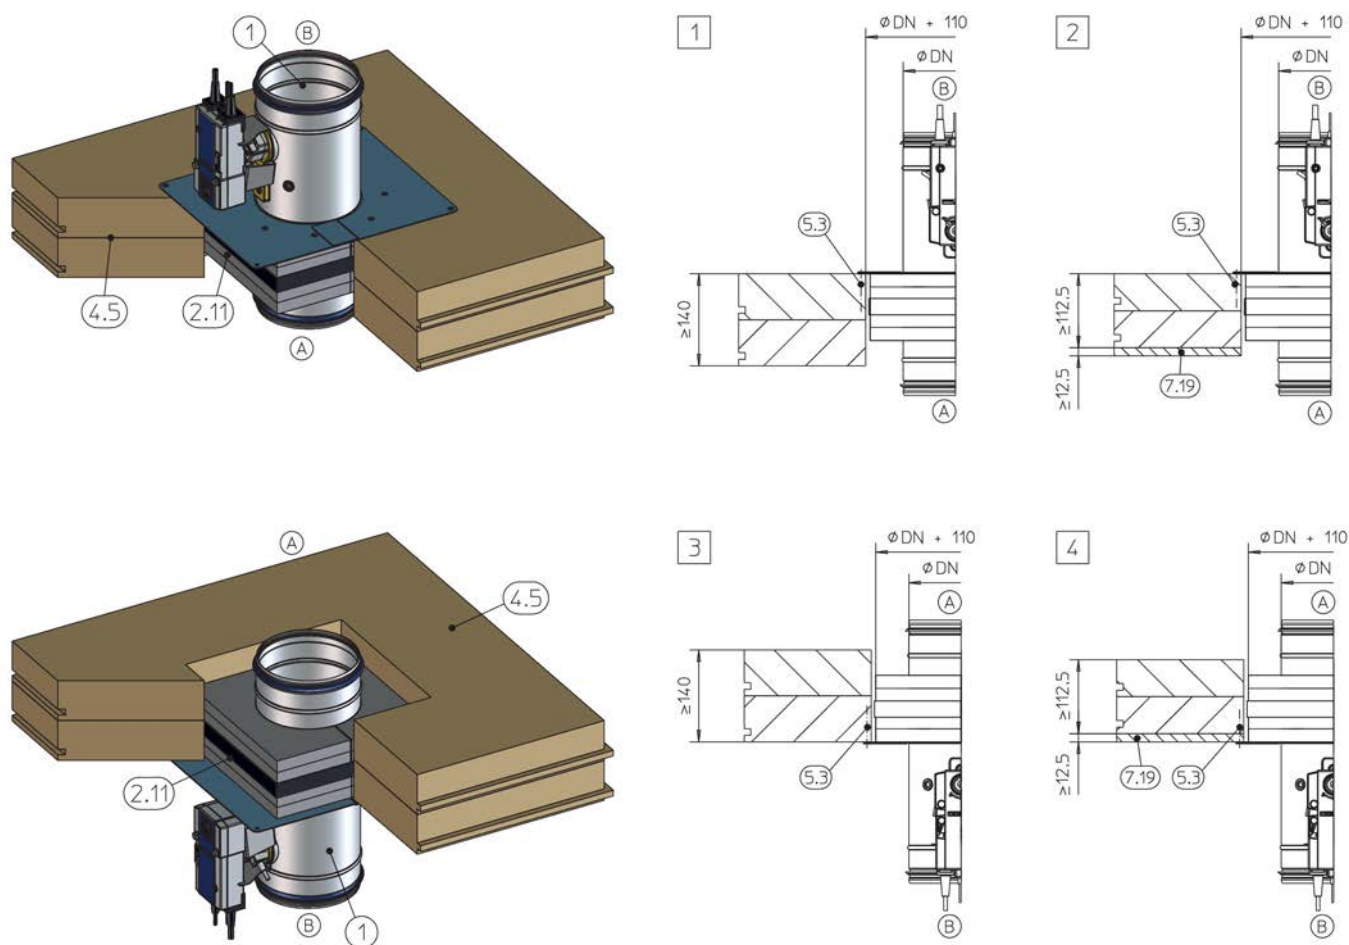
Installazione a base di malta in un soffitto pieno in legno, verticale o sospesa
